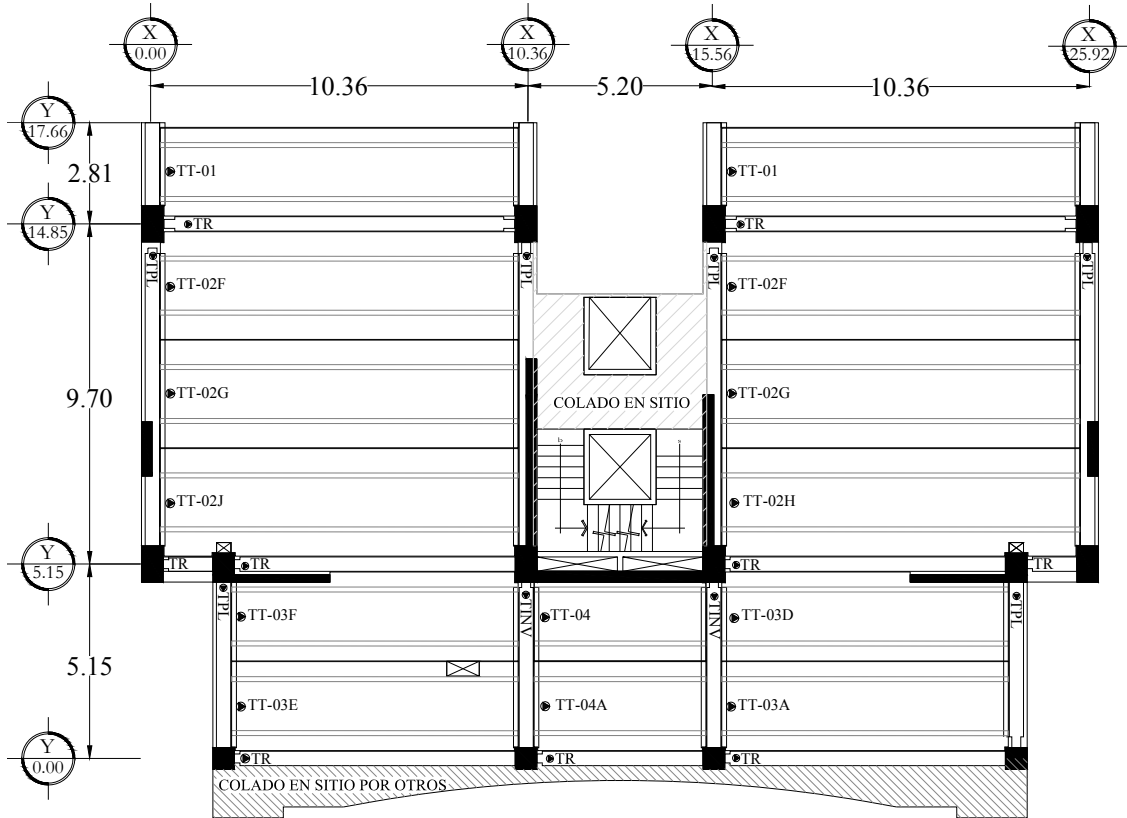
Planta estructural del tercer al doceavo nivel, cotas en m.
